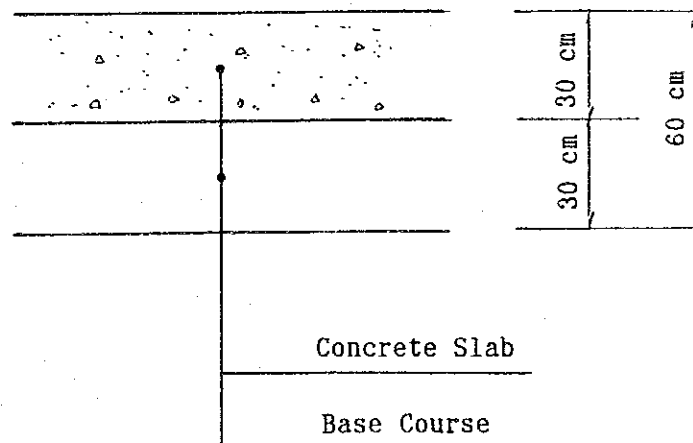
Coupe Transversale de Pavage de Béton
